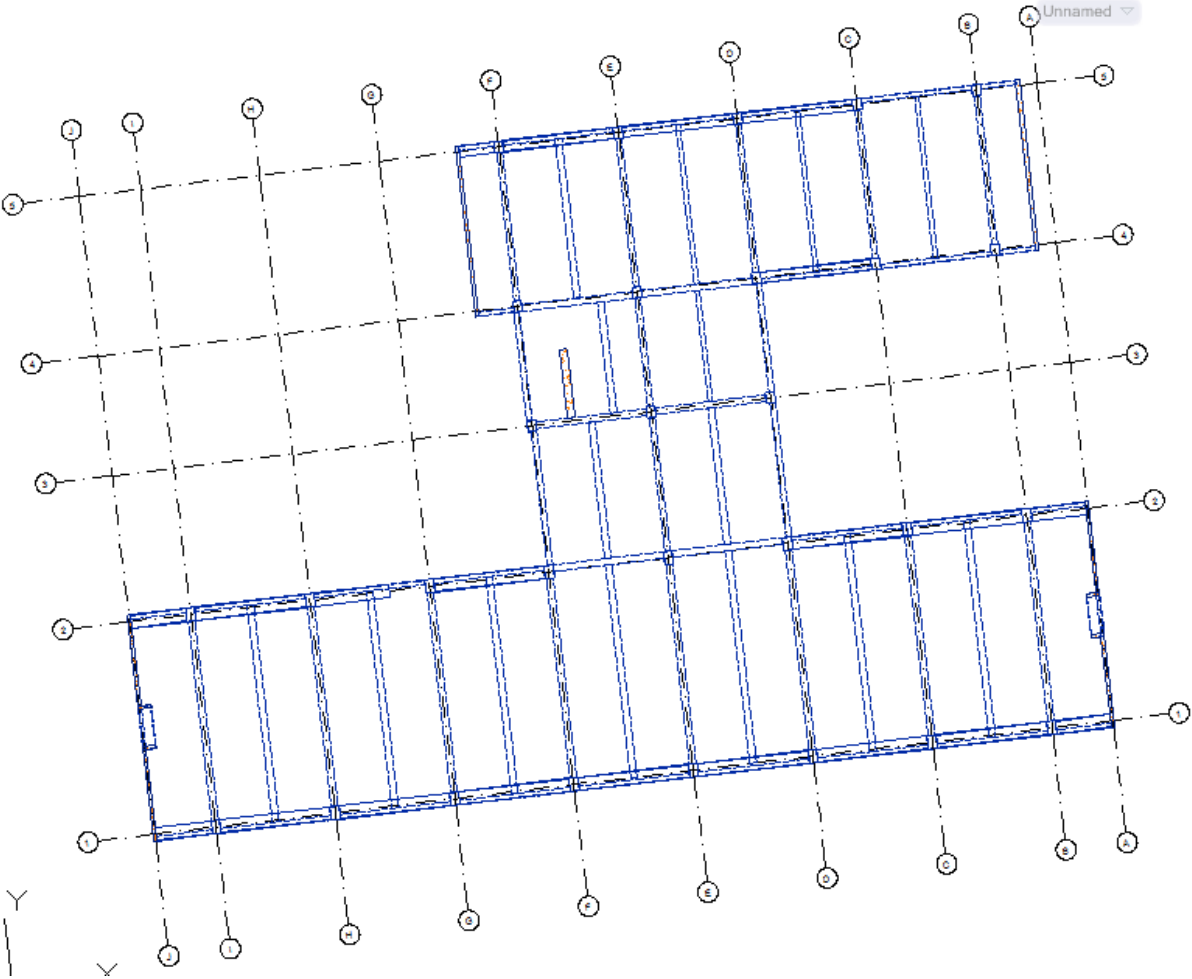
Vista en 2D, en Planta de la retícula estructural de la Planta Baja.
